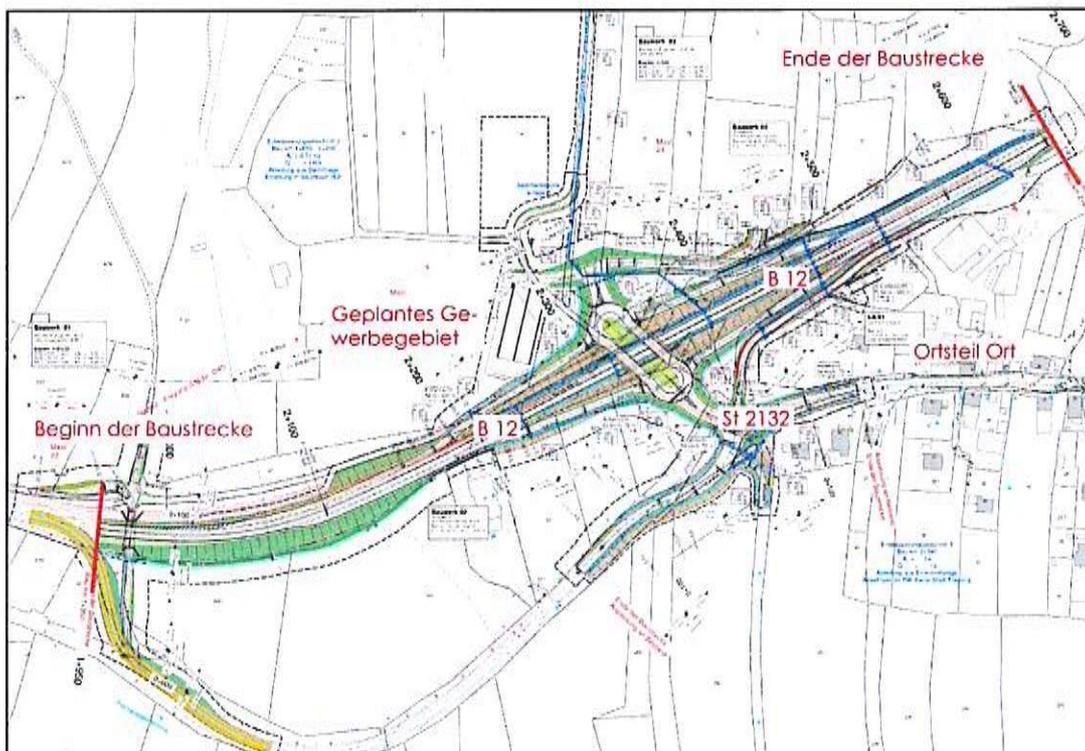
Übersichtslageplan mit Kennzeichnung der Ausbaustrecke /73/
